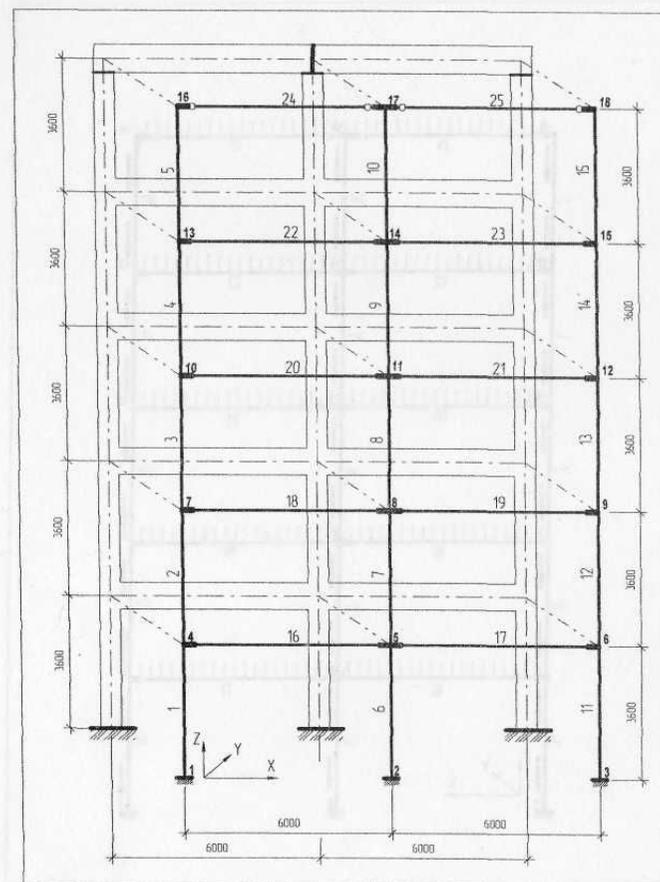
Монолитная железобетонная рама промышленного здания. Расчетная схема рамы. (Цифрами обозначены номера узлов и номера конечных элементов)
